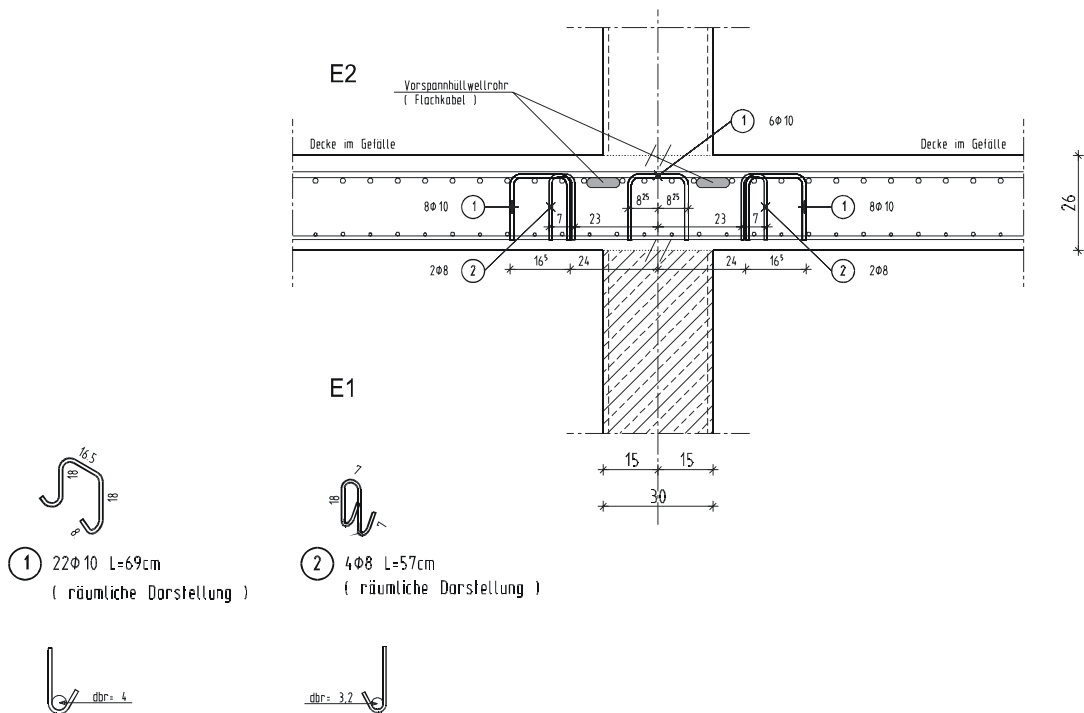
Durchstanzbewehrung einer Regelerdecke [63]
